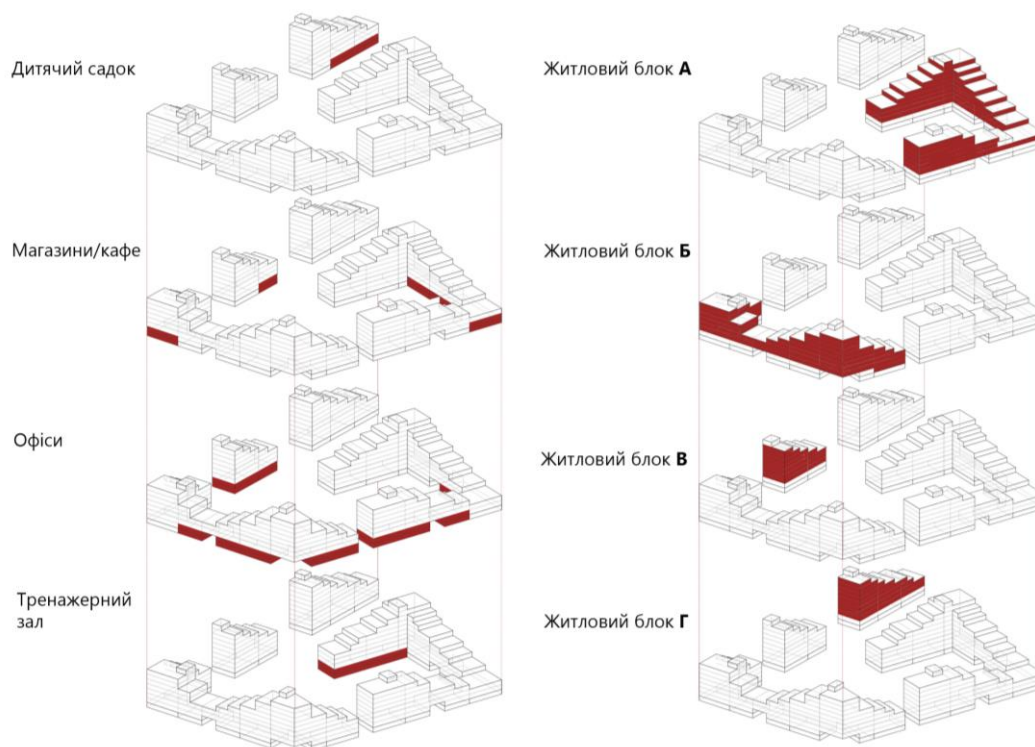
Схема функціонального зонування будівель комплексу.
